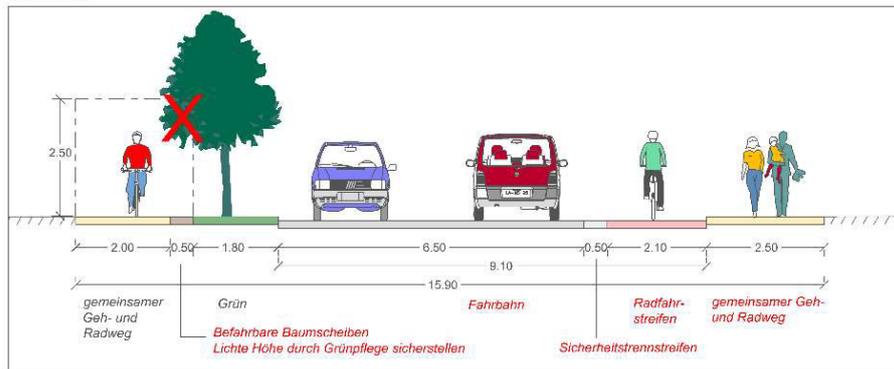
Nordring zw. Raiffeisenstraße und Wiesenstraße: Variante 3
